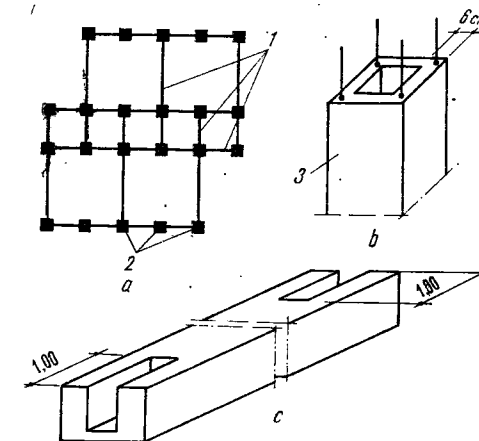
Structură în cadre cu distribuție nesimetrică a stîlpilor și cu deschideri mari: a — schema dispoziției stîlpilor în plan; b — detaliu de stîlp prefabricat cu gol interior; c — detaliu de grindă prefabricată; 1 — grinzii; 2 — stîlpi; 3 — cofraj prefabricat pentru stîlpi care se realizează în două etape.
